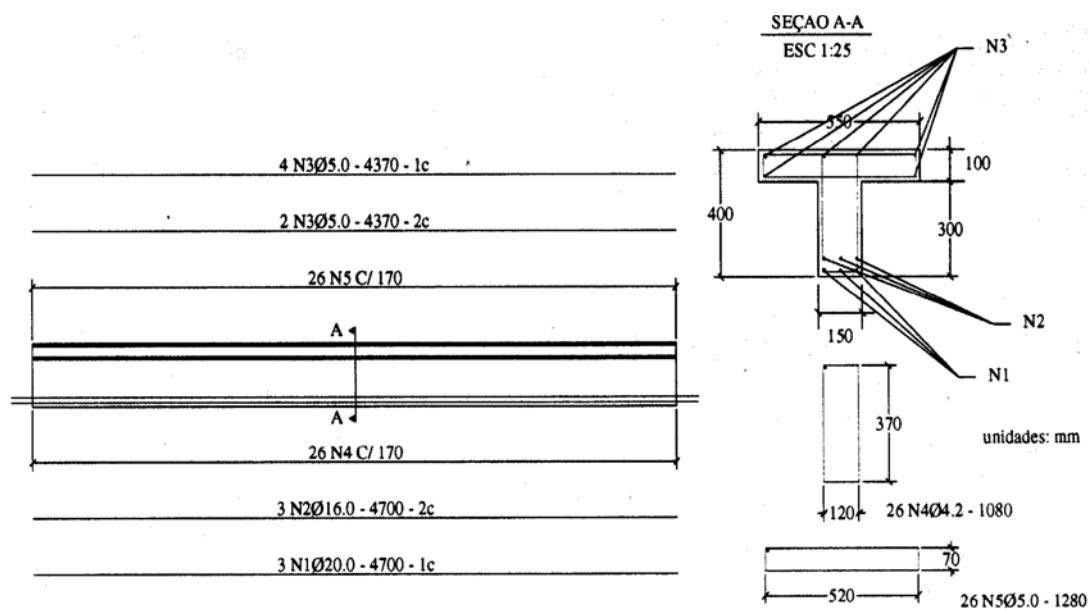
Detalhamento das armaduras; adaptada de Silva Filho (2001).
